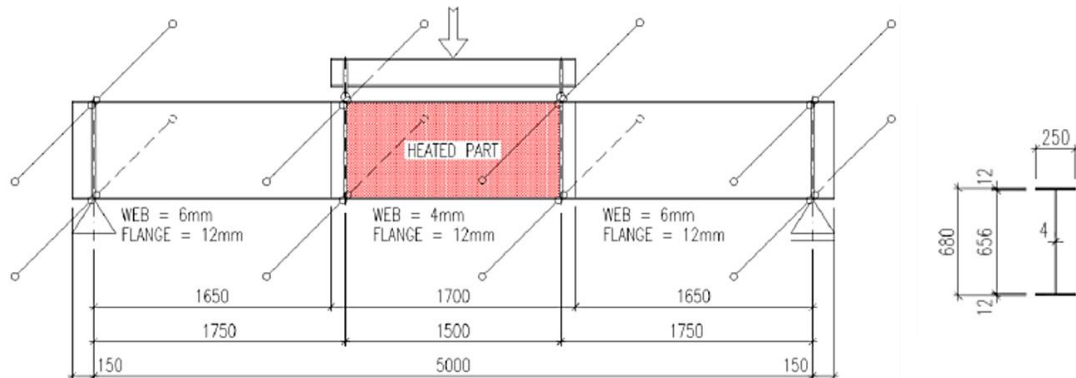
Viga de secção constante sujeita a flexão pura e respetiva secção transversal.
